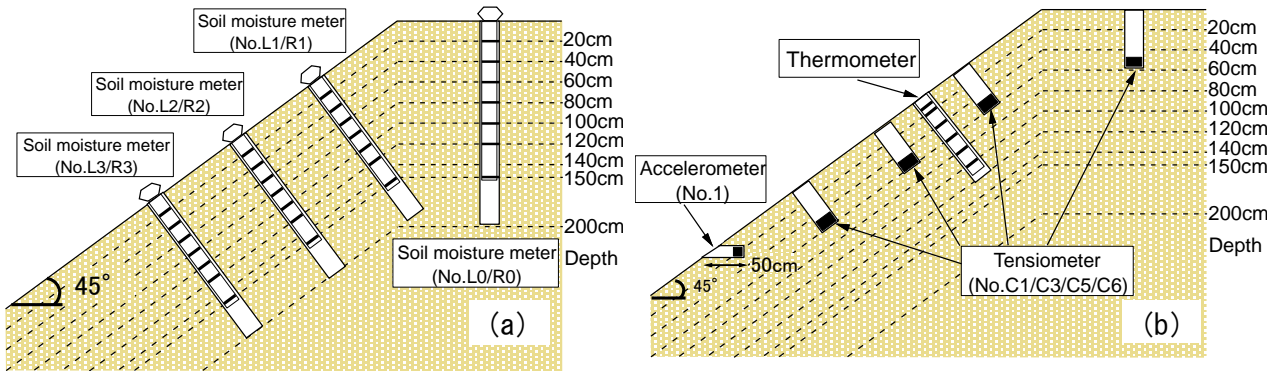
計測機器配置図：(a)L, R断面(断面図)，(b)C断面(断面図)
